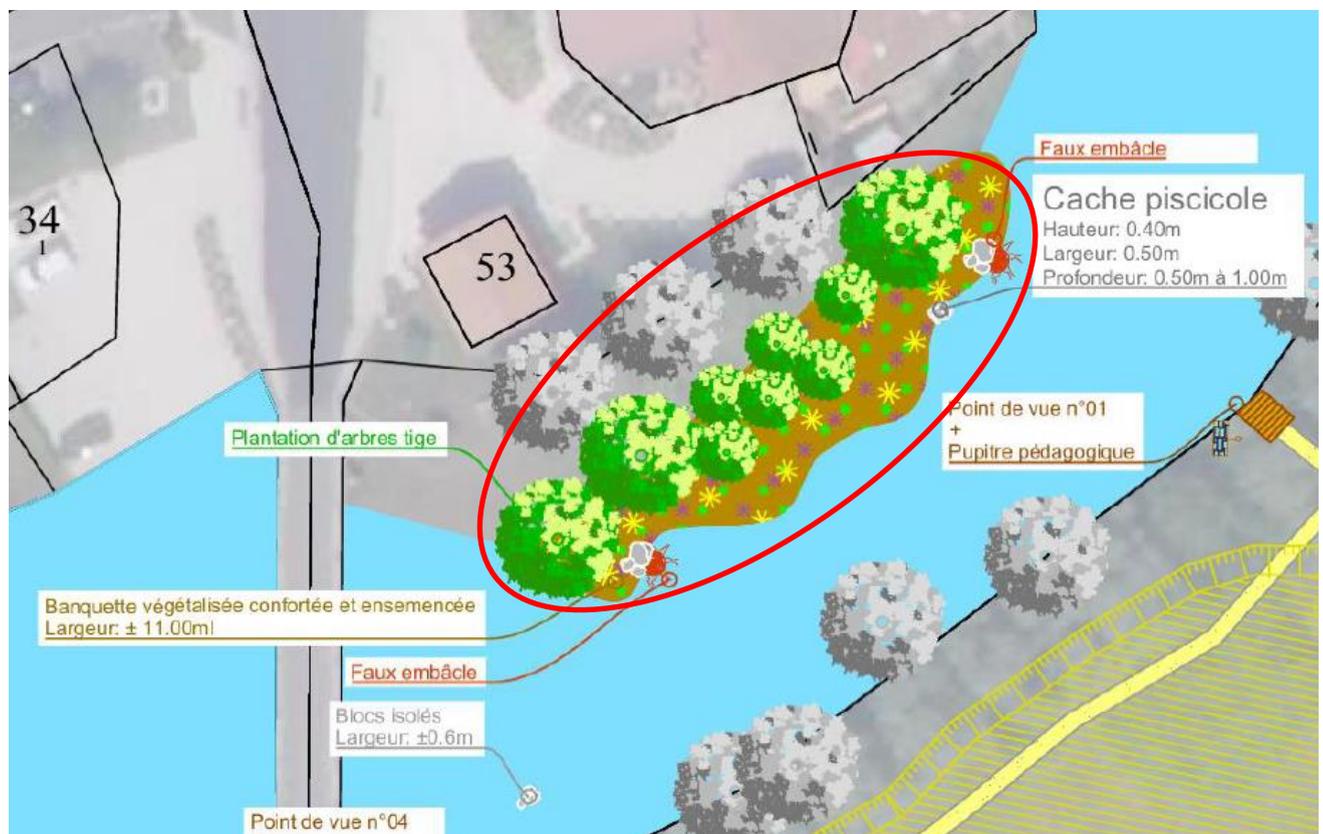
localisation des plantations de ripisylve sur le bras Nord (Source : ARTELIA 2023)
